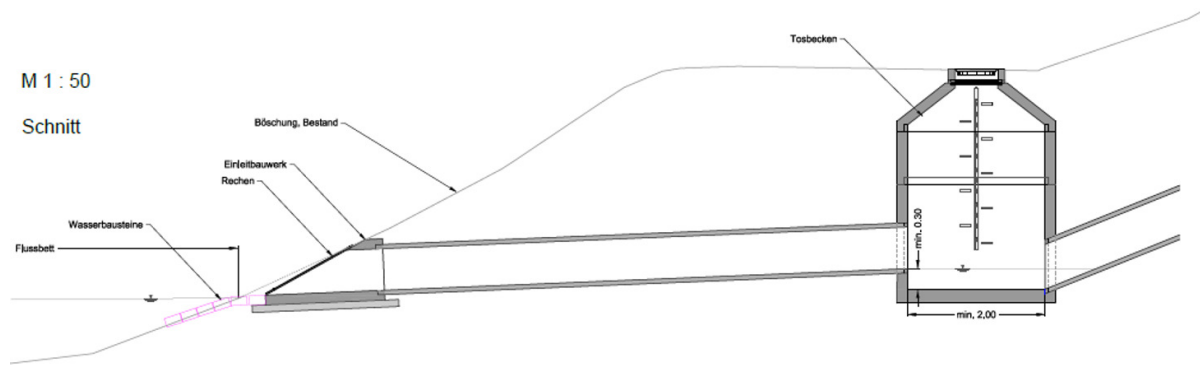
Detailplan Einleitbauwerk mit vorgeschaltetem Toschacht Quelle: Ingenieurgruppe RUK (RUK 2020b)
